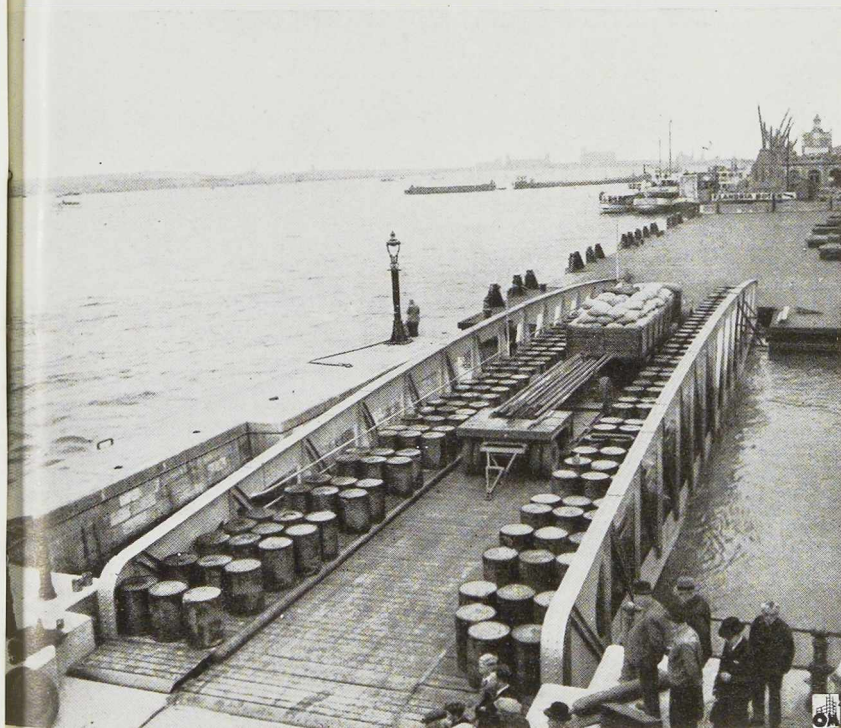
Essai de mise en charge du pont et de stabilité du ponton, au moyen de caisses de chlorure de calcium sur les trottoirs et de camions sur la voie carrossable.
